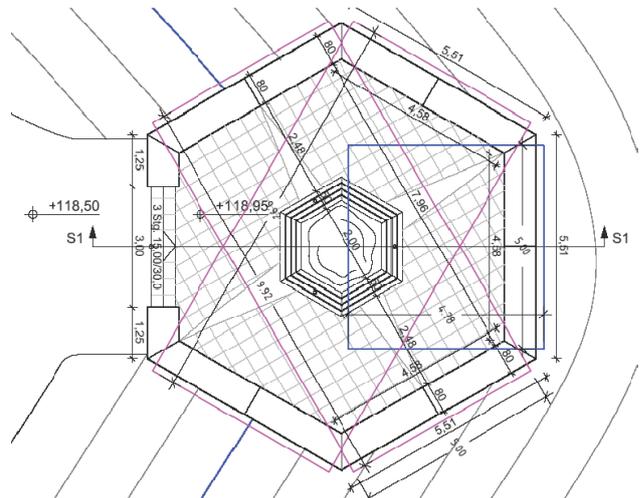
Verlegeplan für den sechseckigen Aussichtsturm
